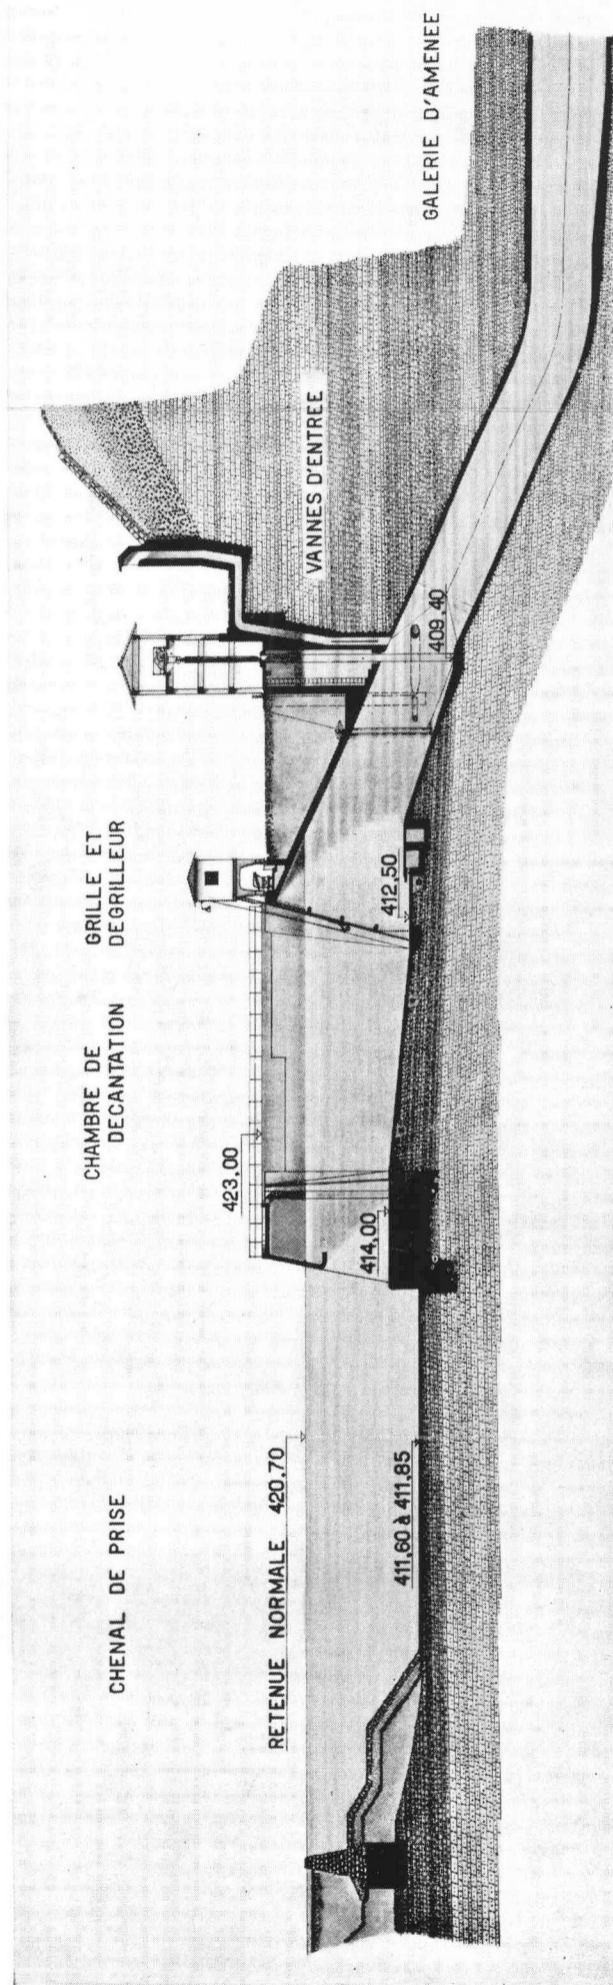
Coupe longitudinale dans les ouvrages de prise d'eau.
